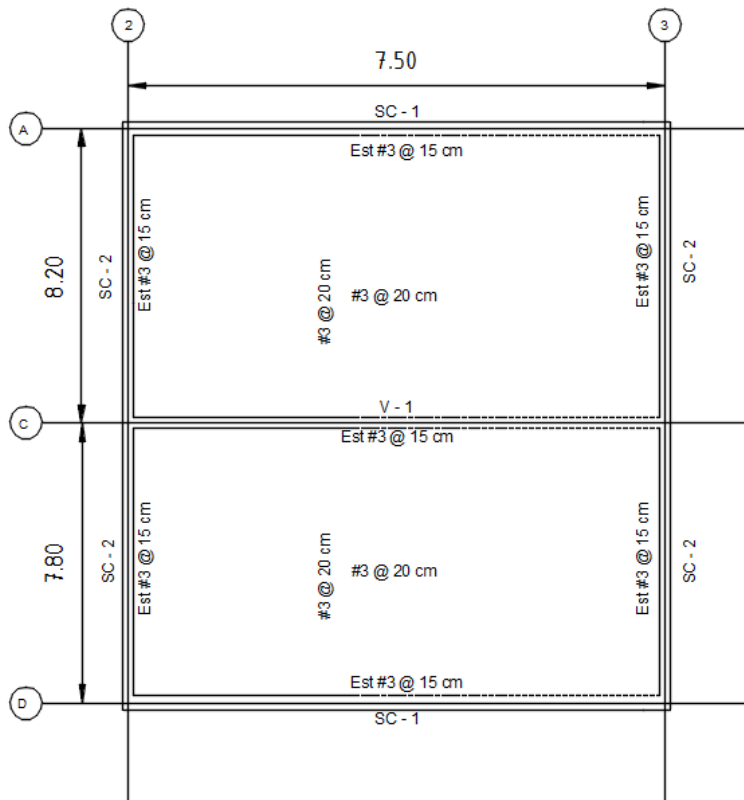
Plano de Taller Losa densa sección transversal, $h = 15$ cm
